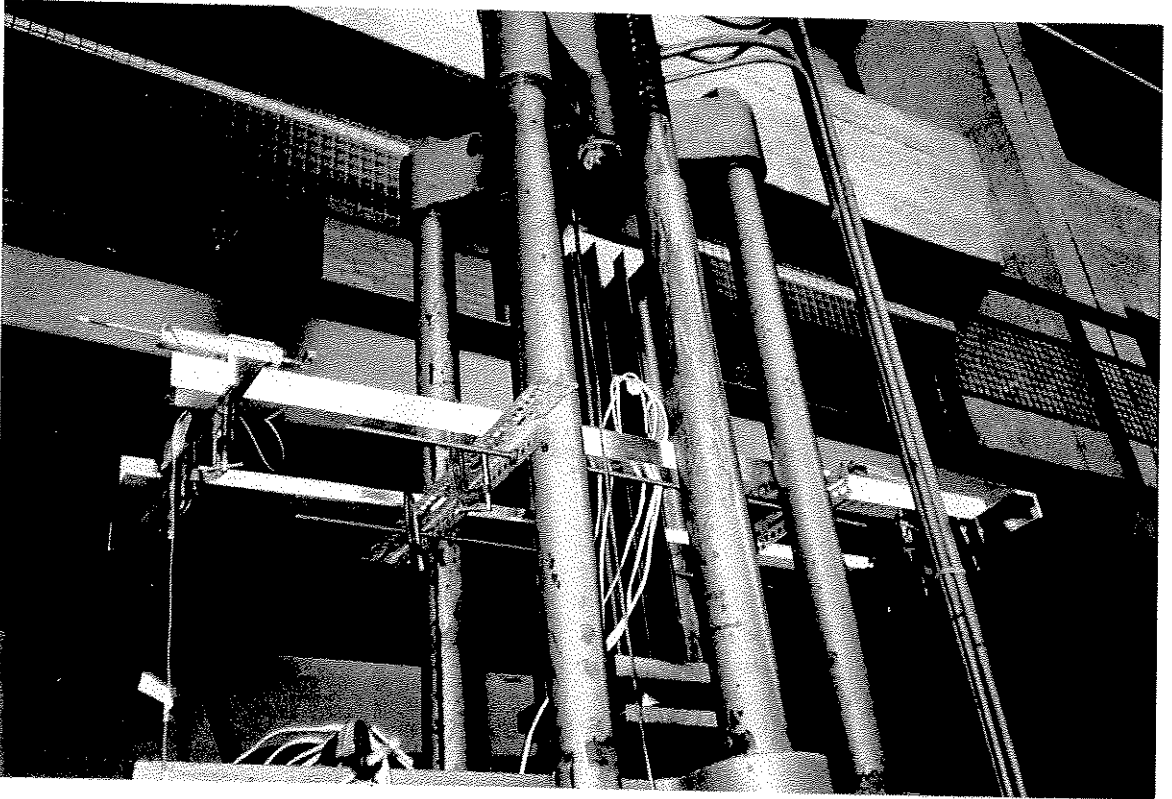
Preparação do ensaio das colunas com comprimento intermediário
